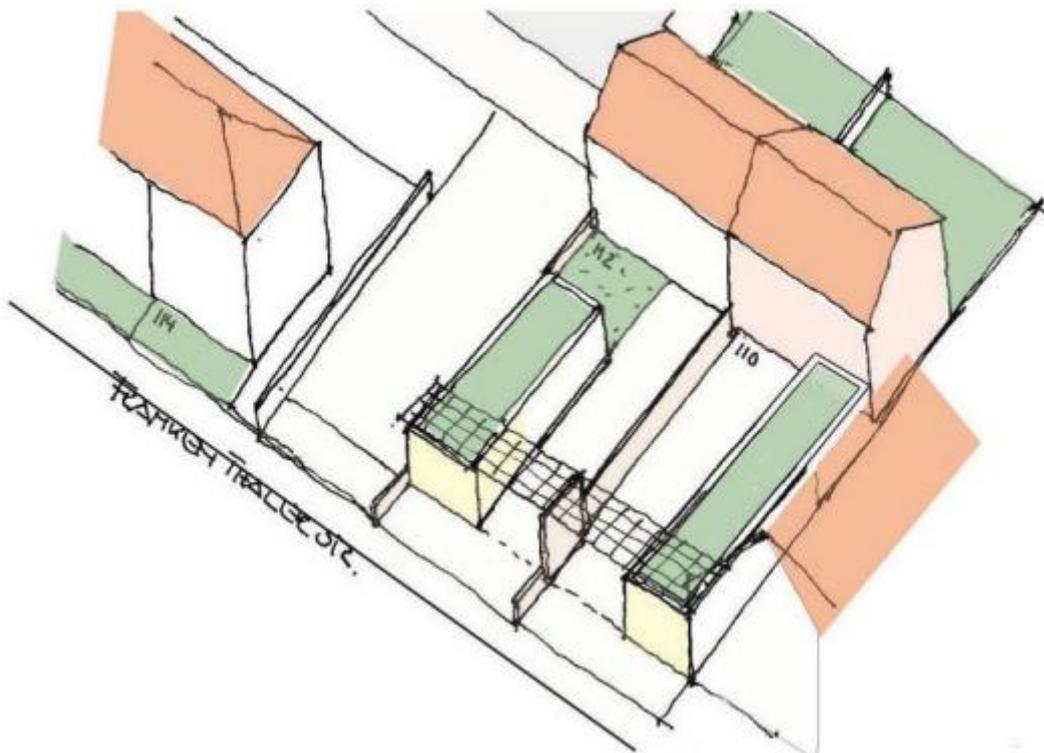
Frankenthaler Straße 110/112 Bebauungsbeispiel Variante 1 mit Pergola
